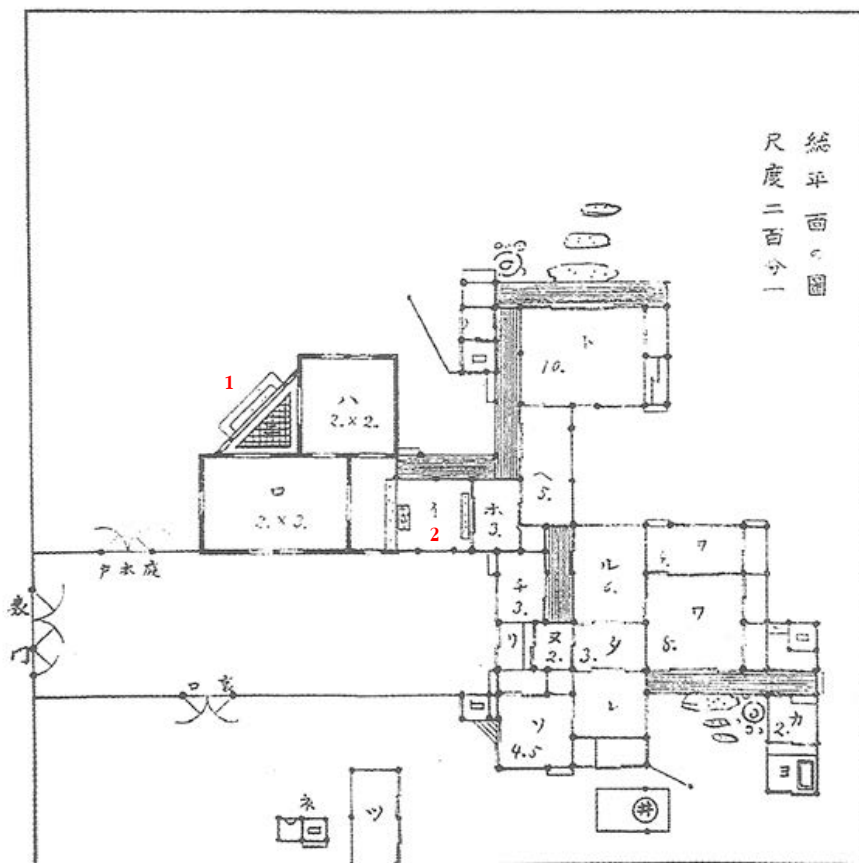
Propuesta en planta de una vivienda híbrida, de Kitada Kyuichi.
